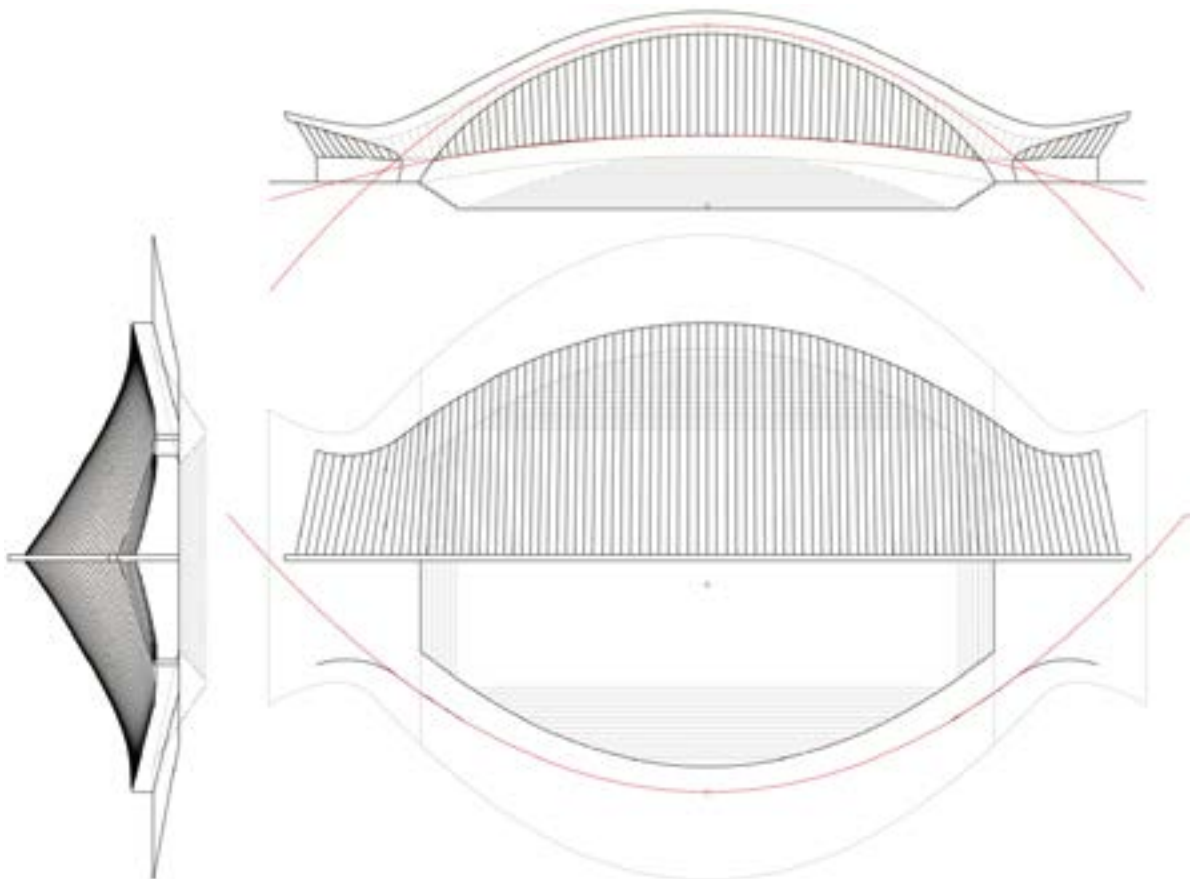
Esquema de planta y alzados del pabellón. Dibujo de los autores.
